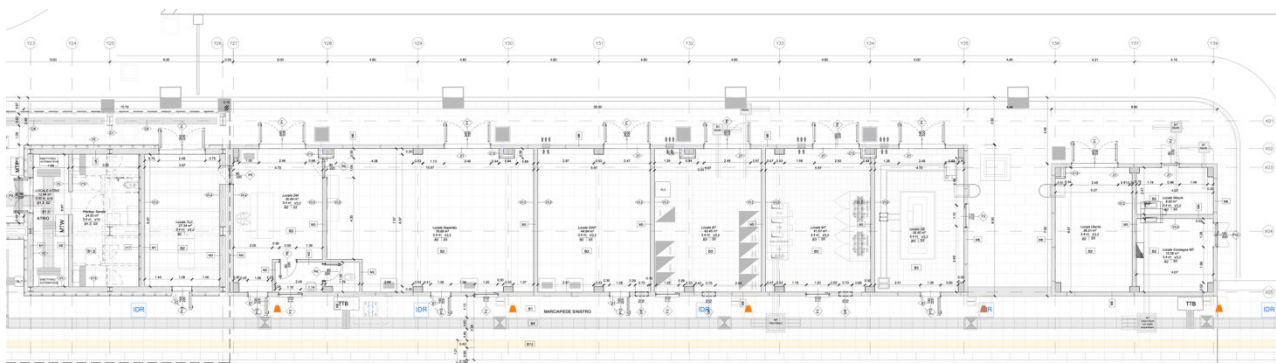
Pianta Fabbricato FA11 (fermata San Lorenzo)
